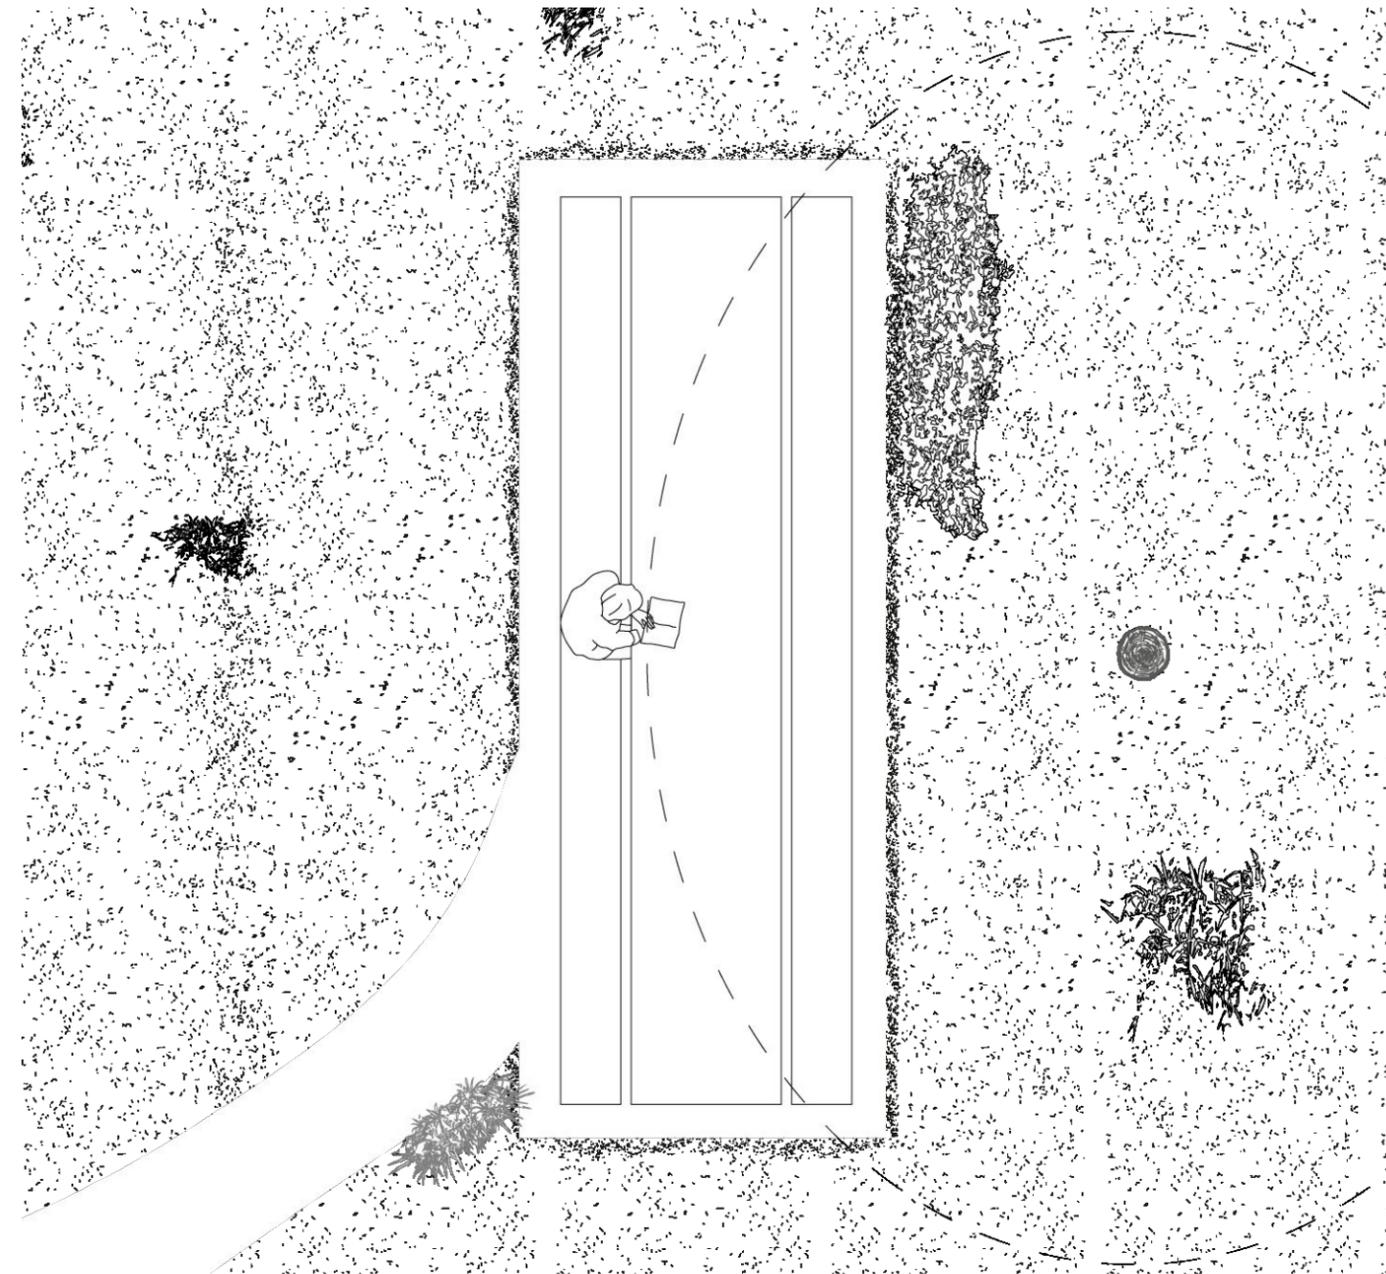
Wegweiser 2; Grundriss M 1:75
